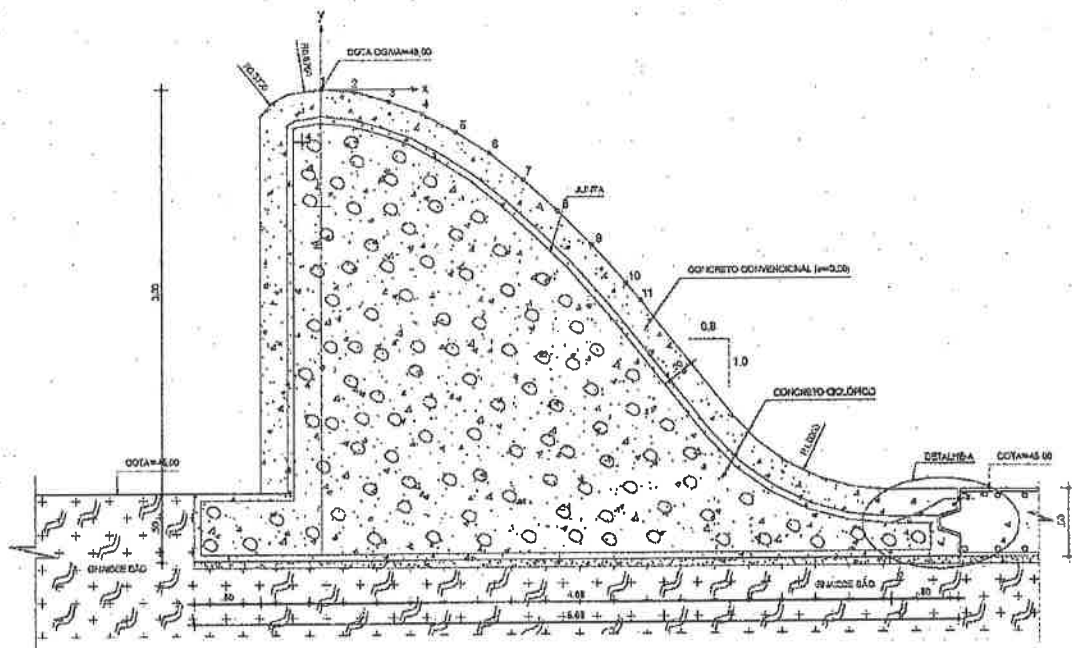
Perfil do vertedouro da Barragem Melancia, conforme projeto executivo.
